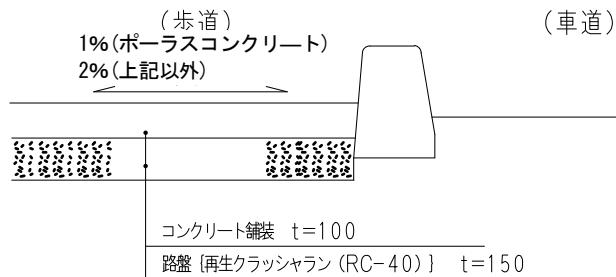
36 コンクリート舗装の構成例 (単位 : mm)
